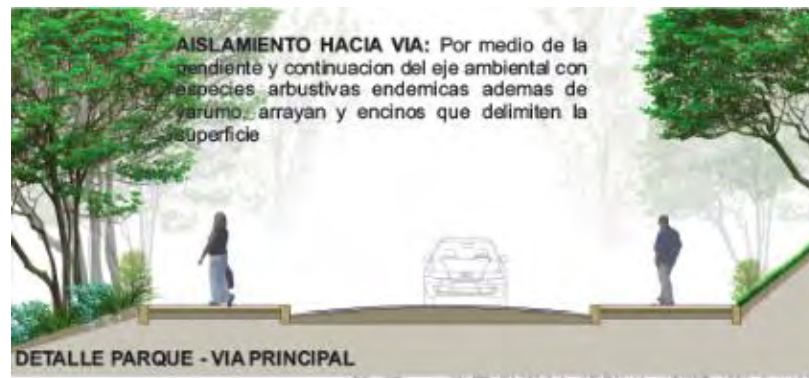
Planteamientos Espacios Detalles Zona 3 Parque Biblioteca 2
